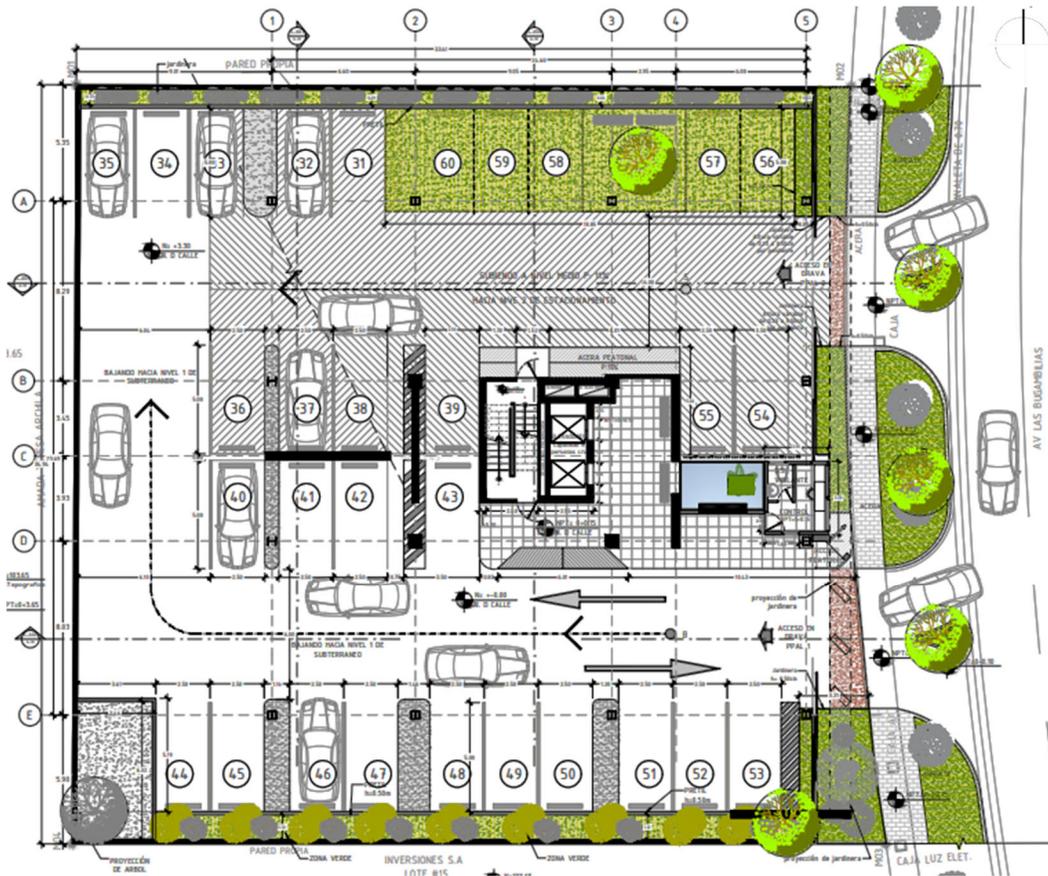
Planta arquitectónica semisótano Nivel de Calle (Extraído de Plano A-3)
